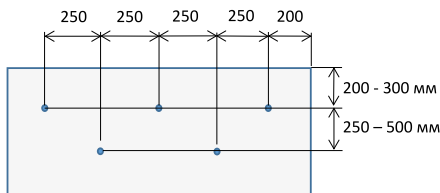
Установка крепежа вдоль карнизного свеса (схематичный рисунок)
